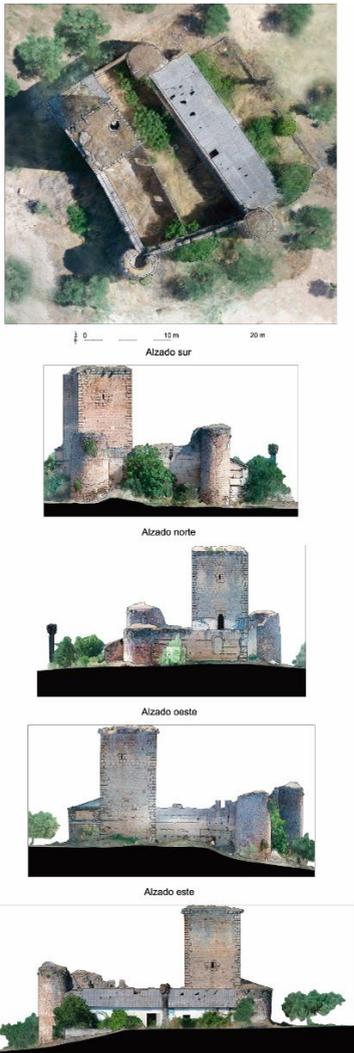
Ortofotografías de la planta y alzados exteriores del recinto de Aragonesa (autor).
